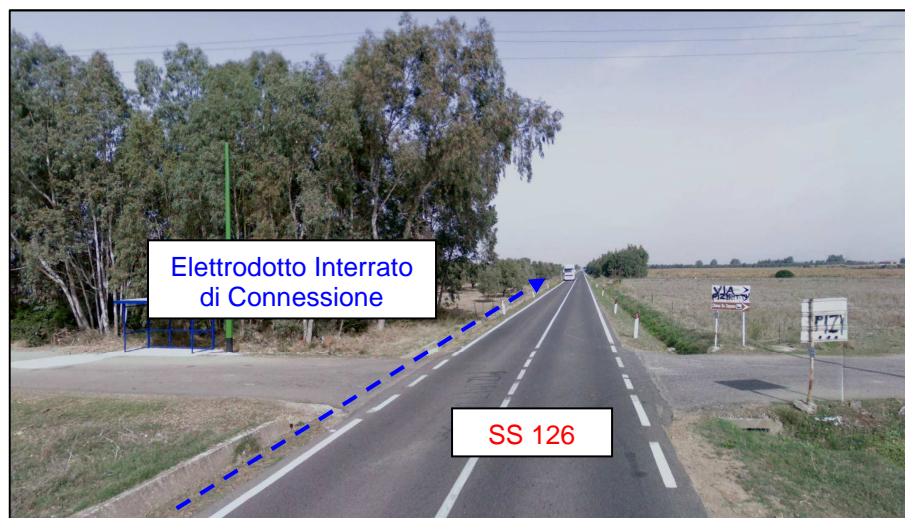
Elettrodoto di Connessione - Attraversamento con strada locale
